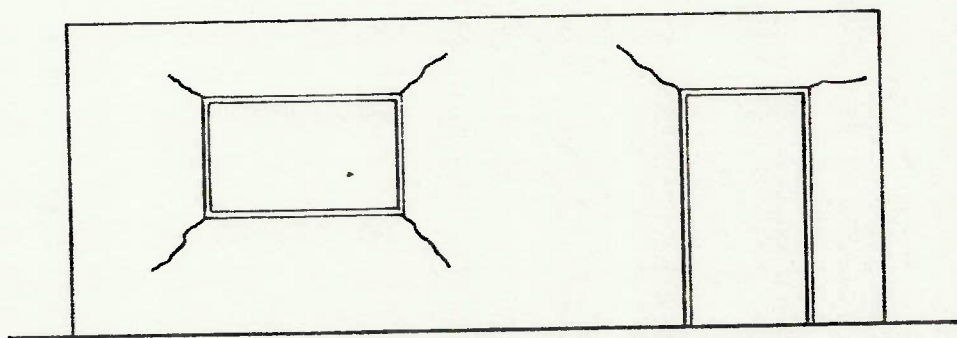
Fissuração típica (real) nos cantos das aberturas, sob atuação de sobrecargas
